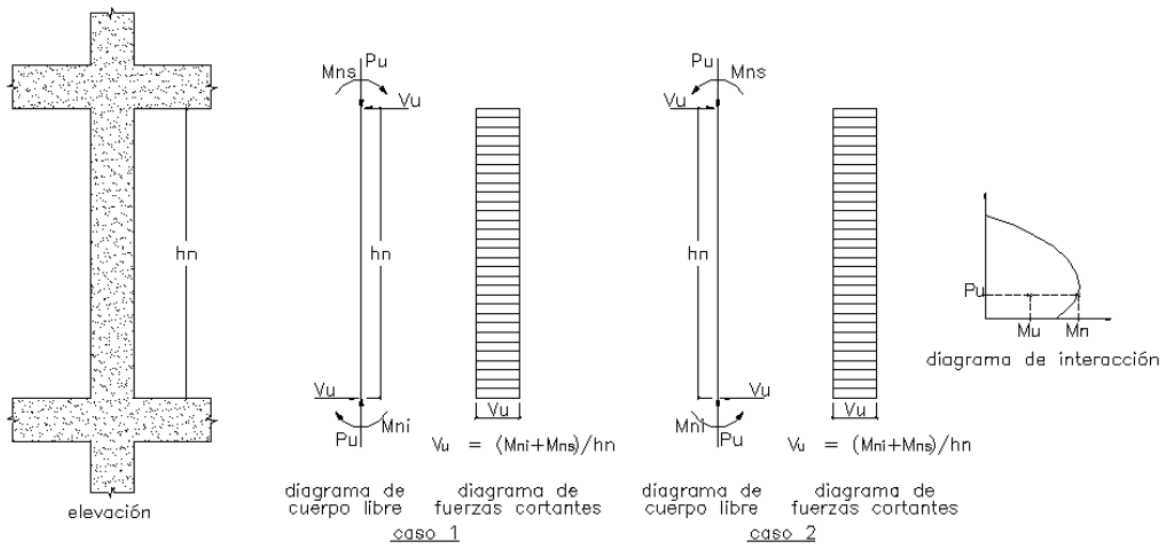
Cortante última para columnas (Figura 21.4.3b de norma E.060 del R.N.E.)
